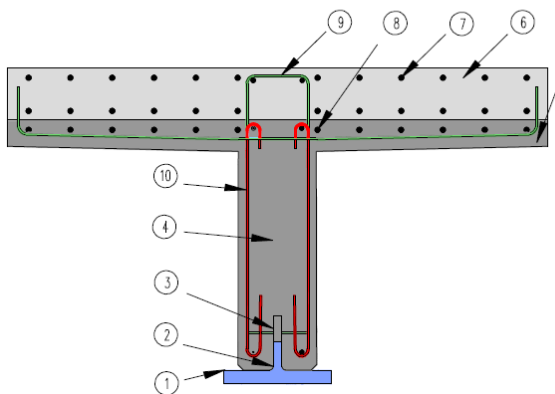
Армування у інноваційних сталезалізобетонних конструкціях
